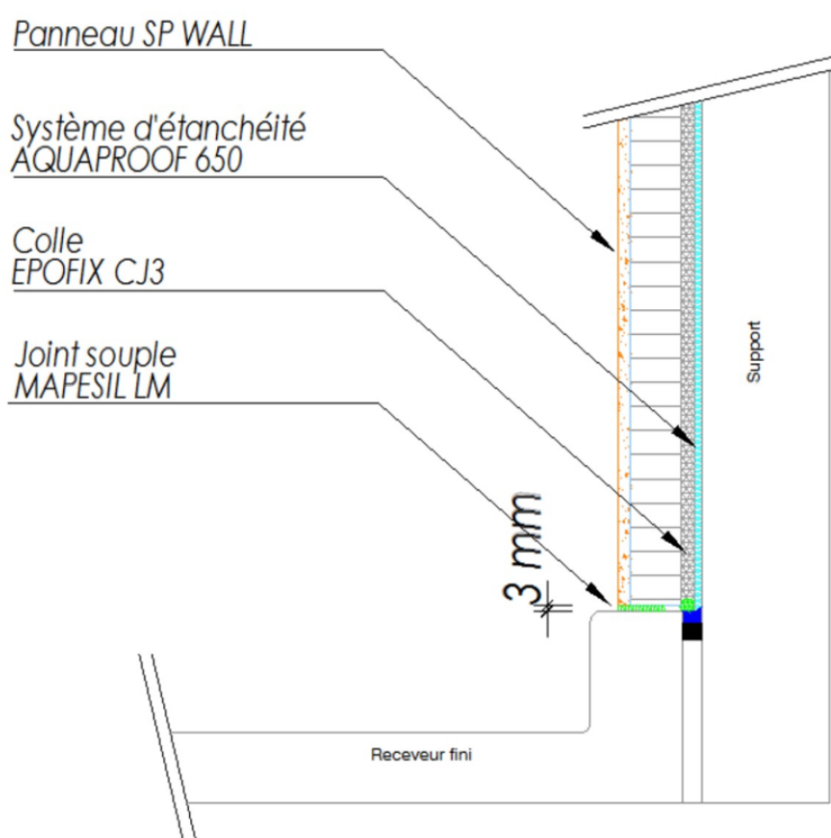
Traitement du raccord entre SP WALL et un receveur de douche en locaux E2
